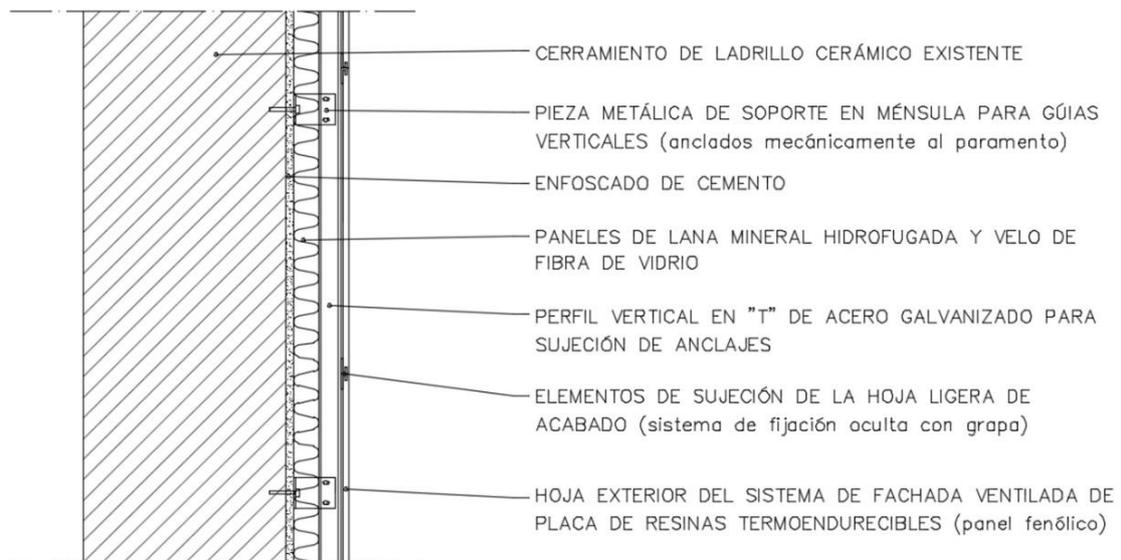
Esquema en sección del sistema de fachada ventilada propuesto. Fuente: elaboración propia
